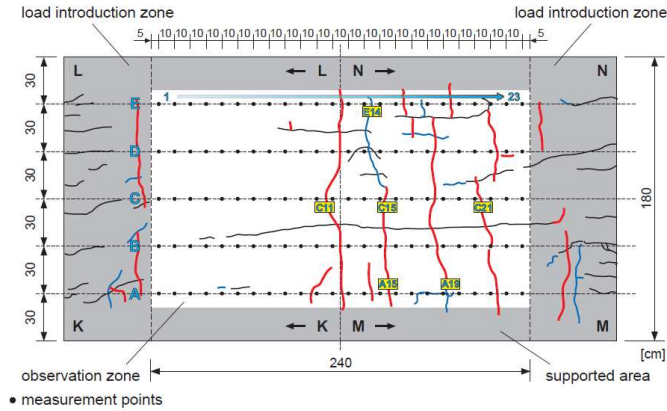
Relevé de fissuration sur la face inférieure de la dalle avant le RUN 6. Les capteurs d'ouverture de fissure sont indiqués en jaune.
